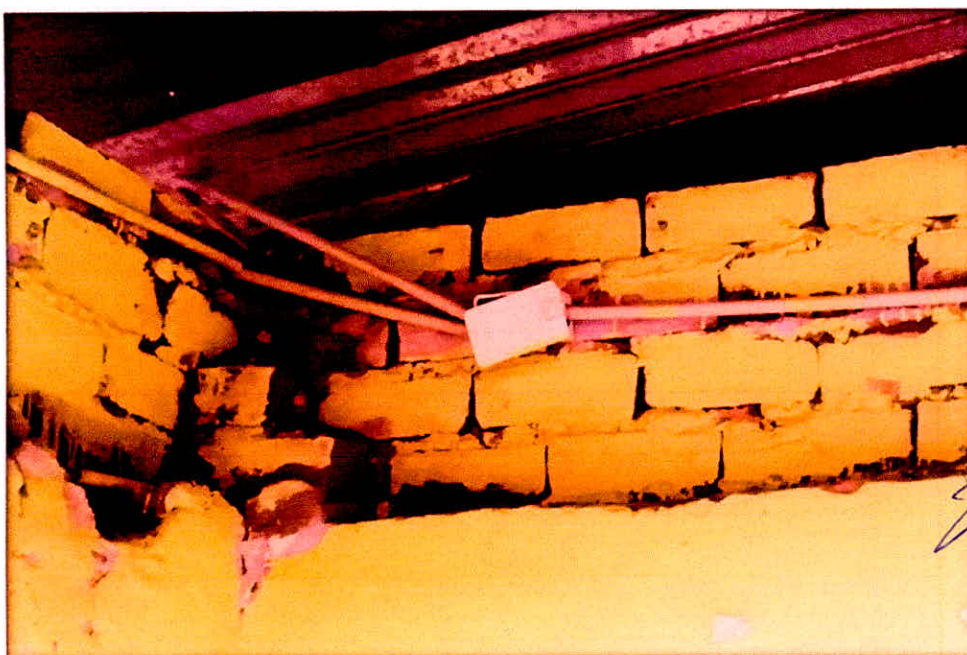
Observamos caja de pase y tuberías mal colocadas y en mal estado.
